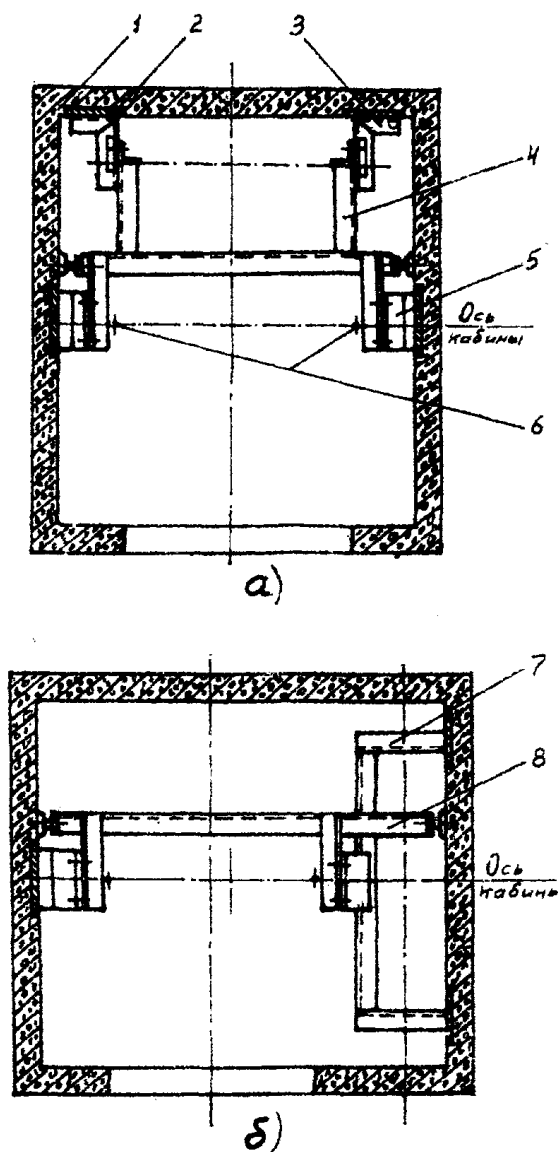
Кондукторы для установки кронштейнов крепления направляющих:
